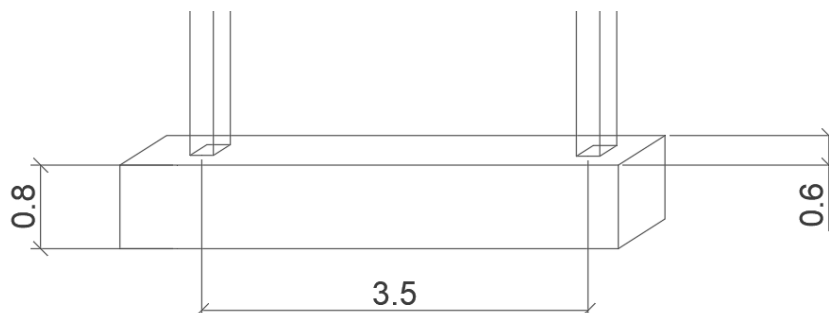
Dimensiones de la zapata y separación máxima entre pilares (metros)
